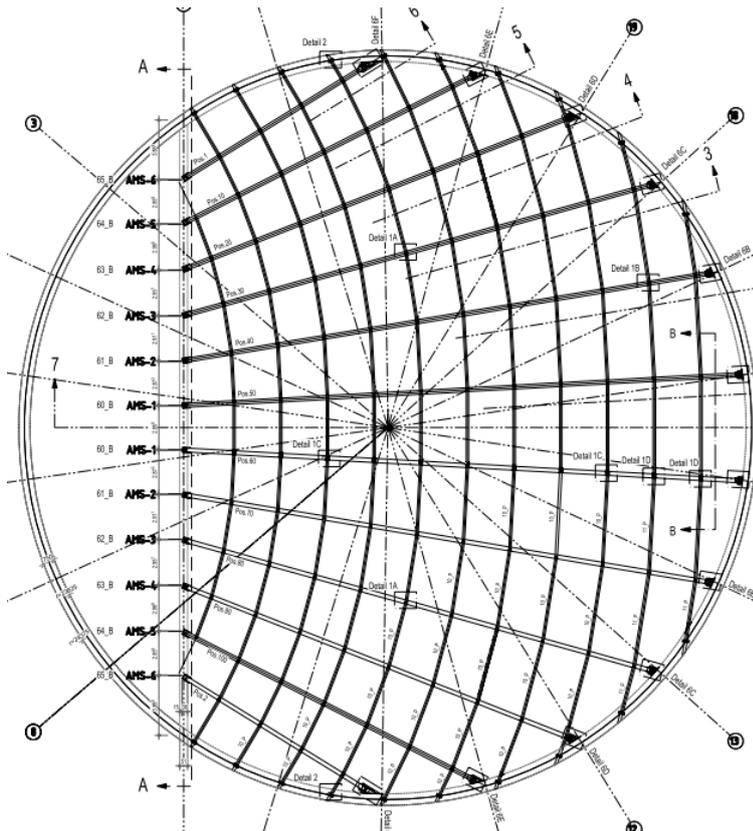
Grundriss der Multifunktionshalle in Palanga
